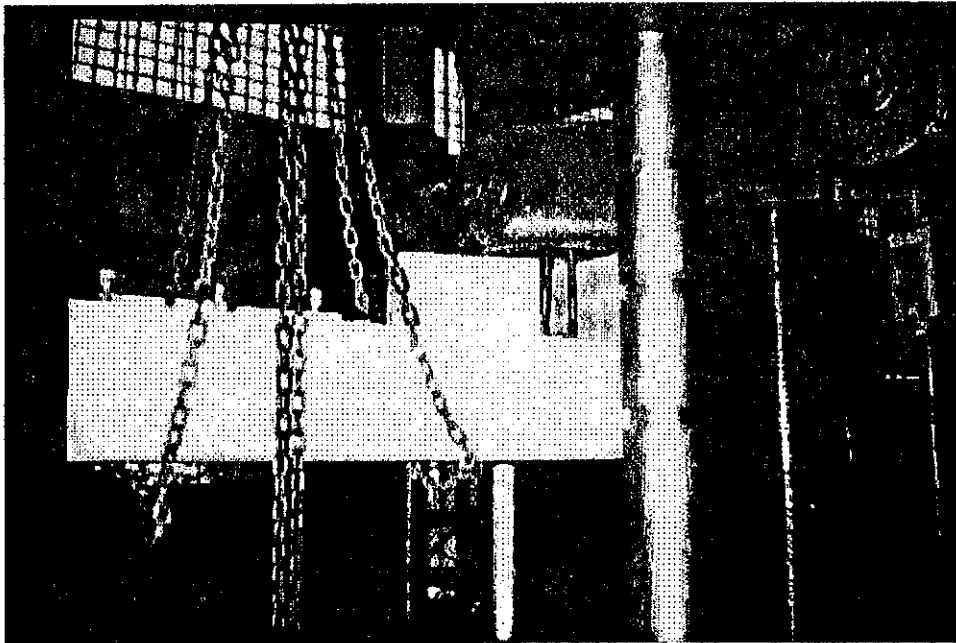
A y B representan el Anclaje que es ensayado, donde se puede observar la aplicación de fuerza de tracción.
